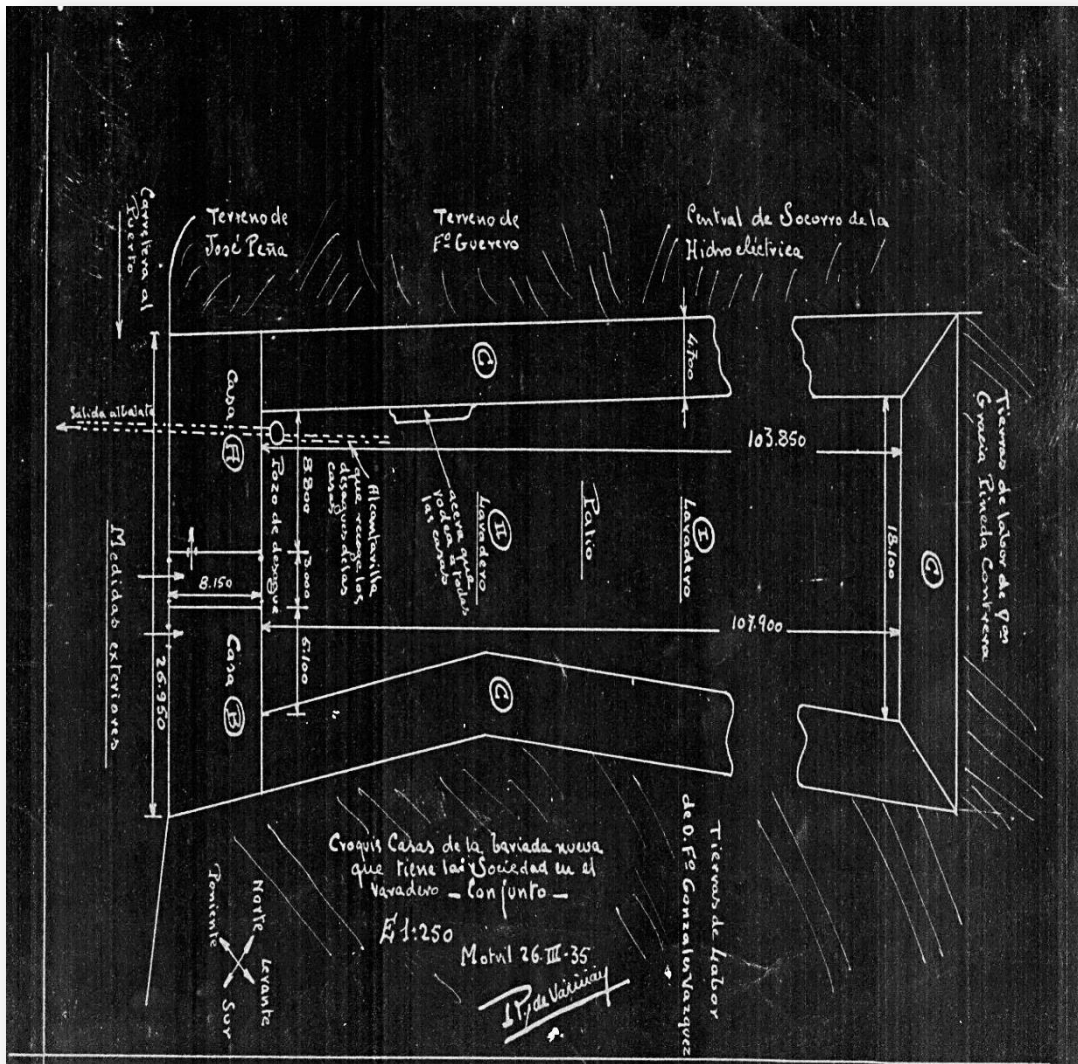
Plano de las viviendas de la Barriada Nueva en el Varadero. Motril, 26 de marzo de 1935. Fuente: ASGAE
